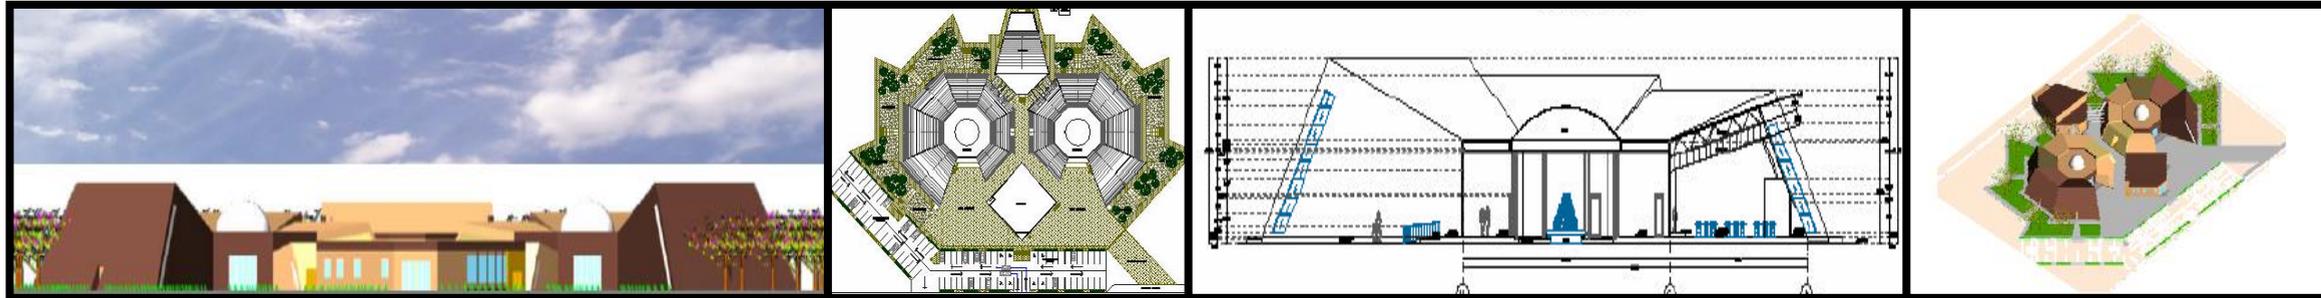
Proyecto de Centro Cultural.
